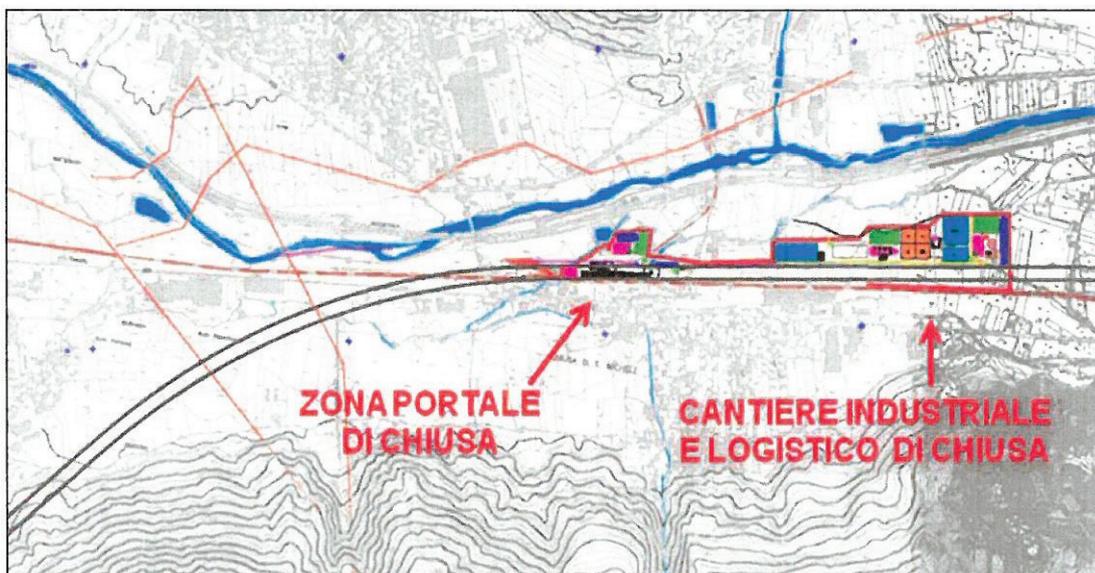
Cantieri nell'area di Piana delle Chiuse.
